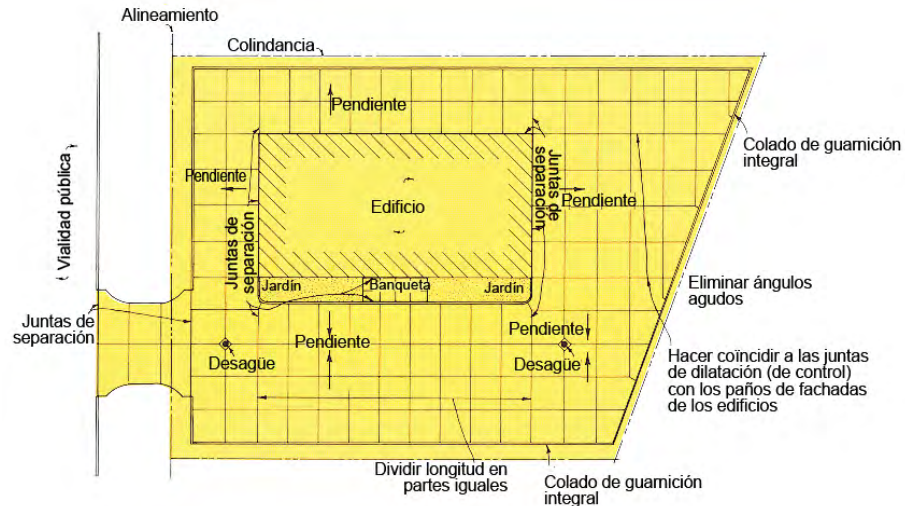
EJEMPLO DE DESPIECE DE JUNTAS en un área exterior pavimentada de estacionamiento.
